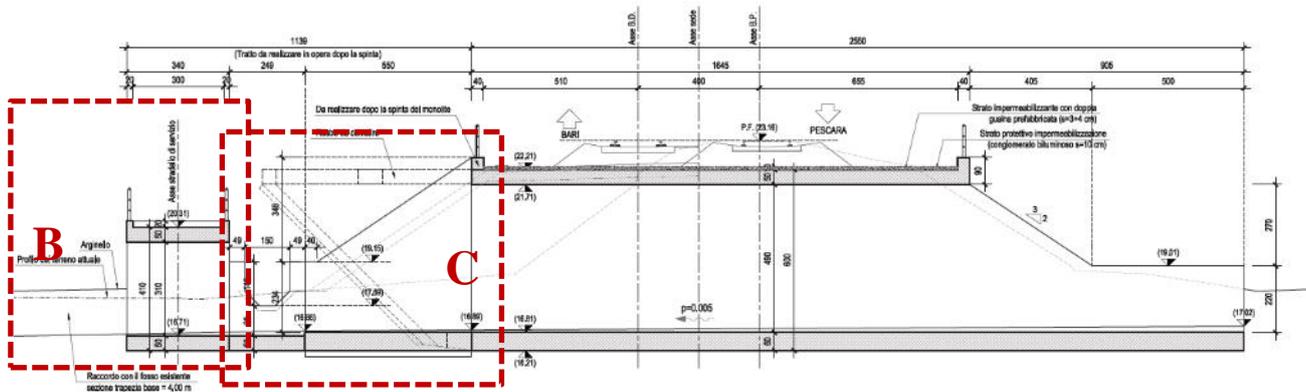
Adeguamento idraulico Fosso Capoposta - Sezione Longitudinale sovrappasso stradello di servizio ed elemento di raccordo
